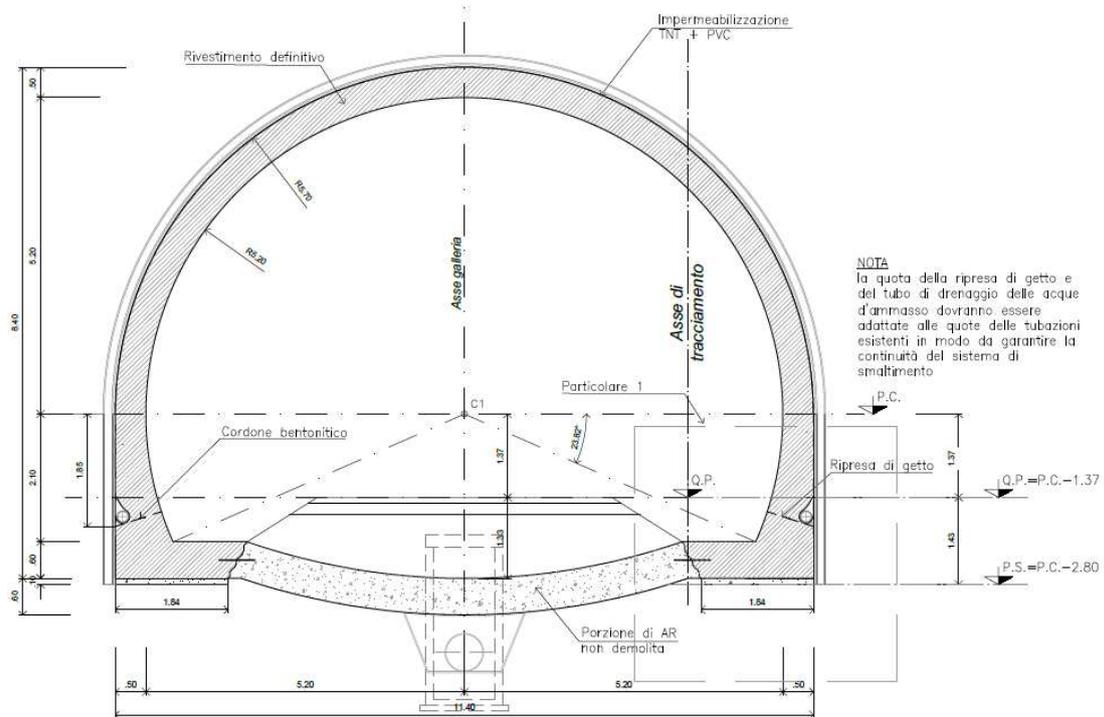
Galleria Guinza – Intervento Tipo A – Sezione corrente – Carpenteria
